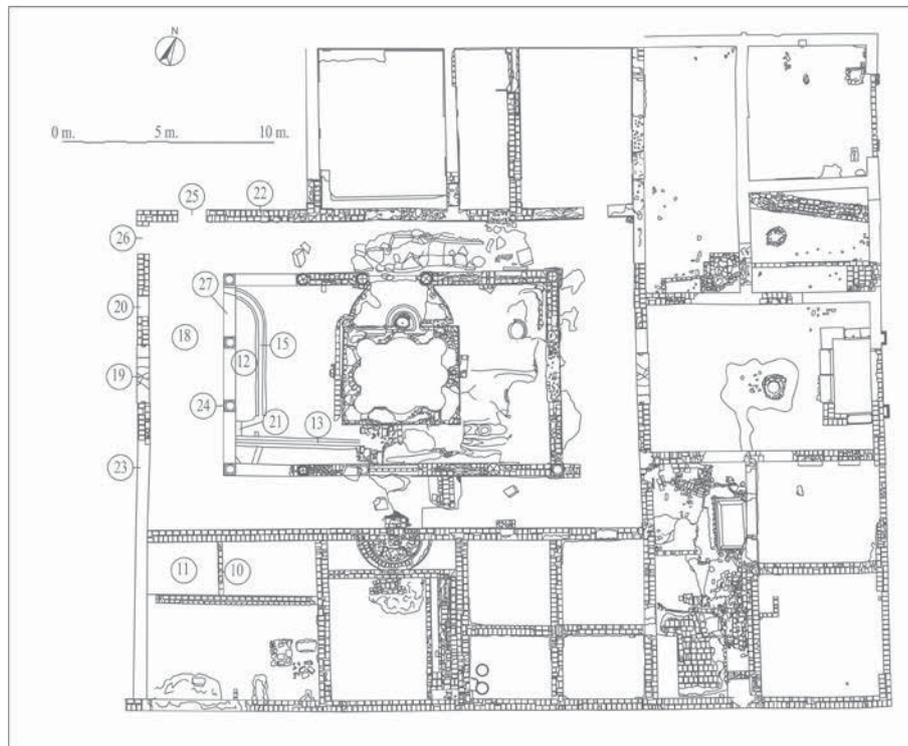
Planta de la Casa de la Cañada Honda tras la intervención.
